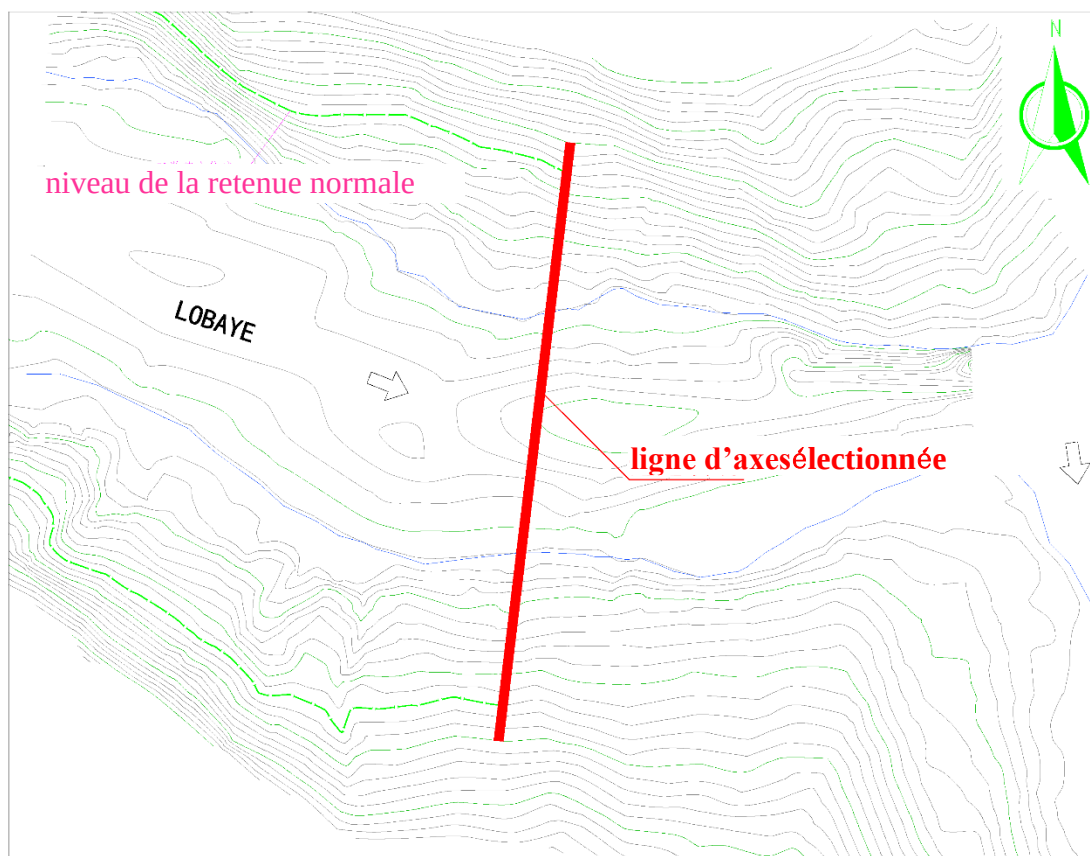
Schéma d'implantation de la ligne d'axe du barrage LOTEMO
